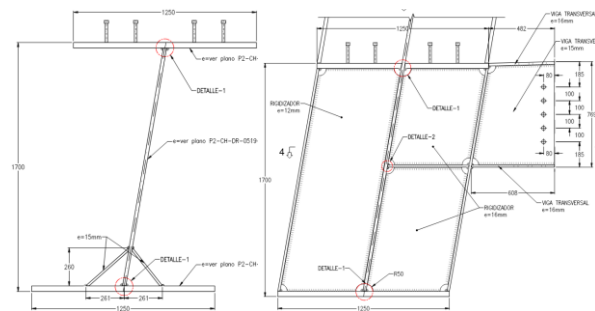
Sección transversal tipo tablero doble T y por zona de arranques en forma de cajón cerrado.
